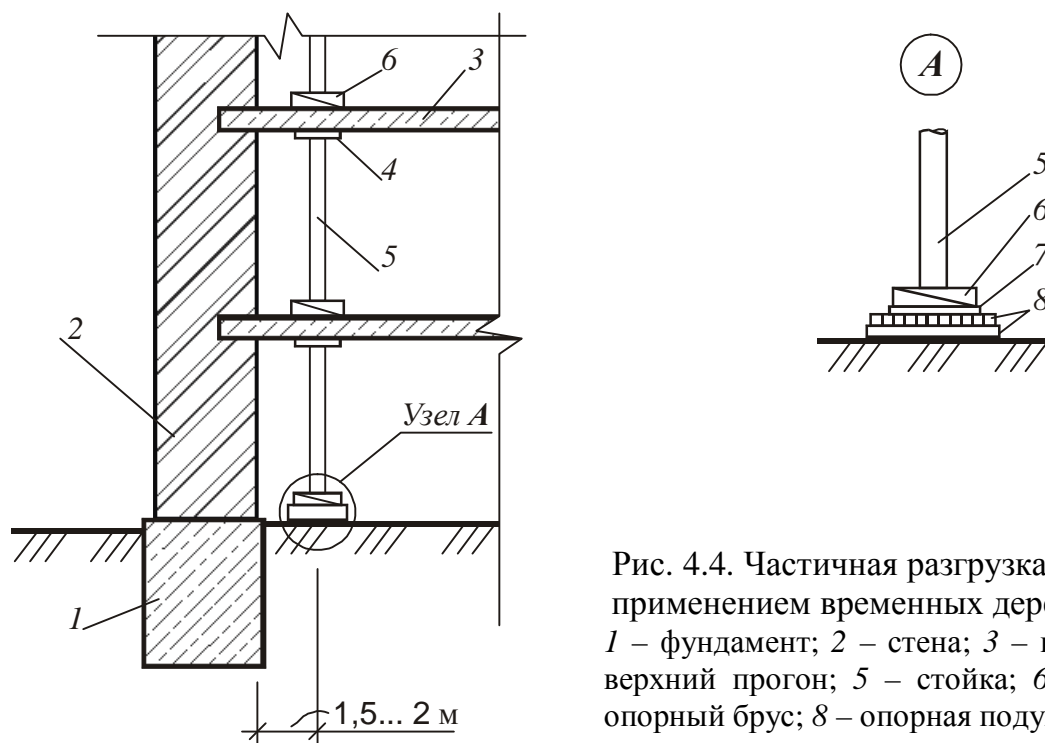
Частичная разгрузка фундамента с применением временных деревянных опор: 1 – фундамент; 2 – стена; 3 – перекрытие; 4 – верхний прогон; 5 – стойка; 6 – клинья; 7 – опорный брус; 8 – опорная подушка
